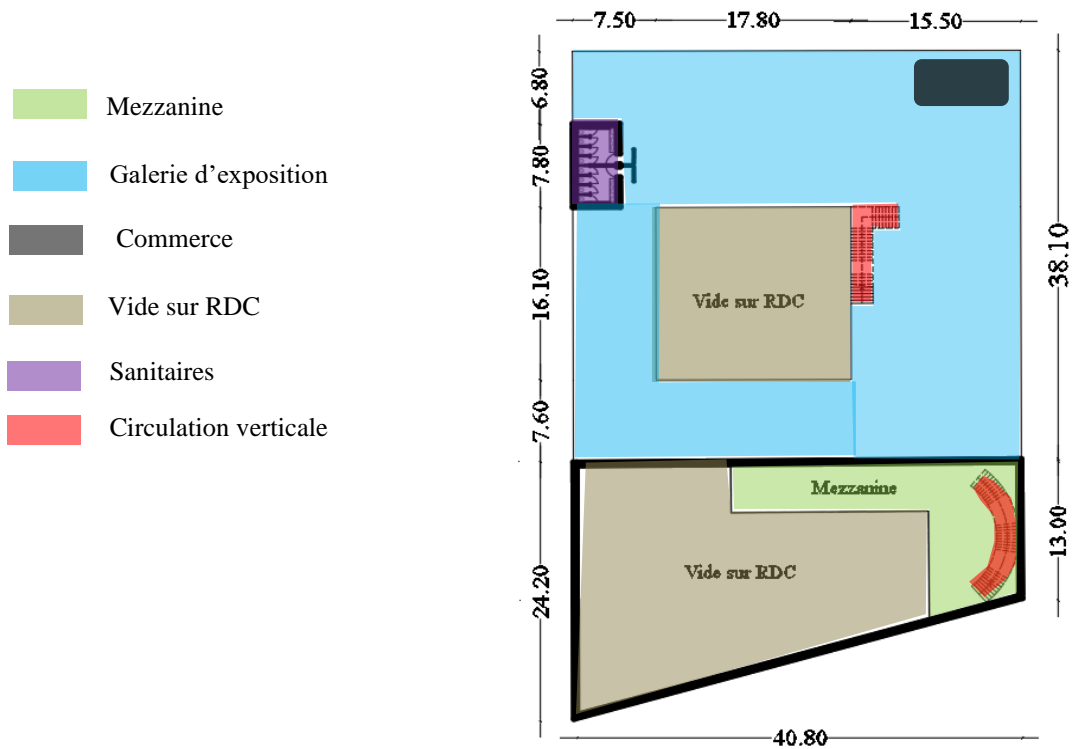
Plan R+1 Ludique. (Source : Auteur)
